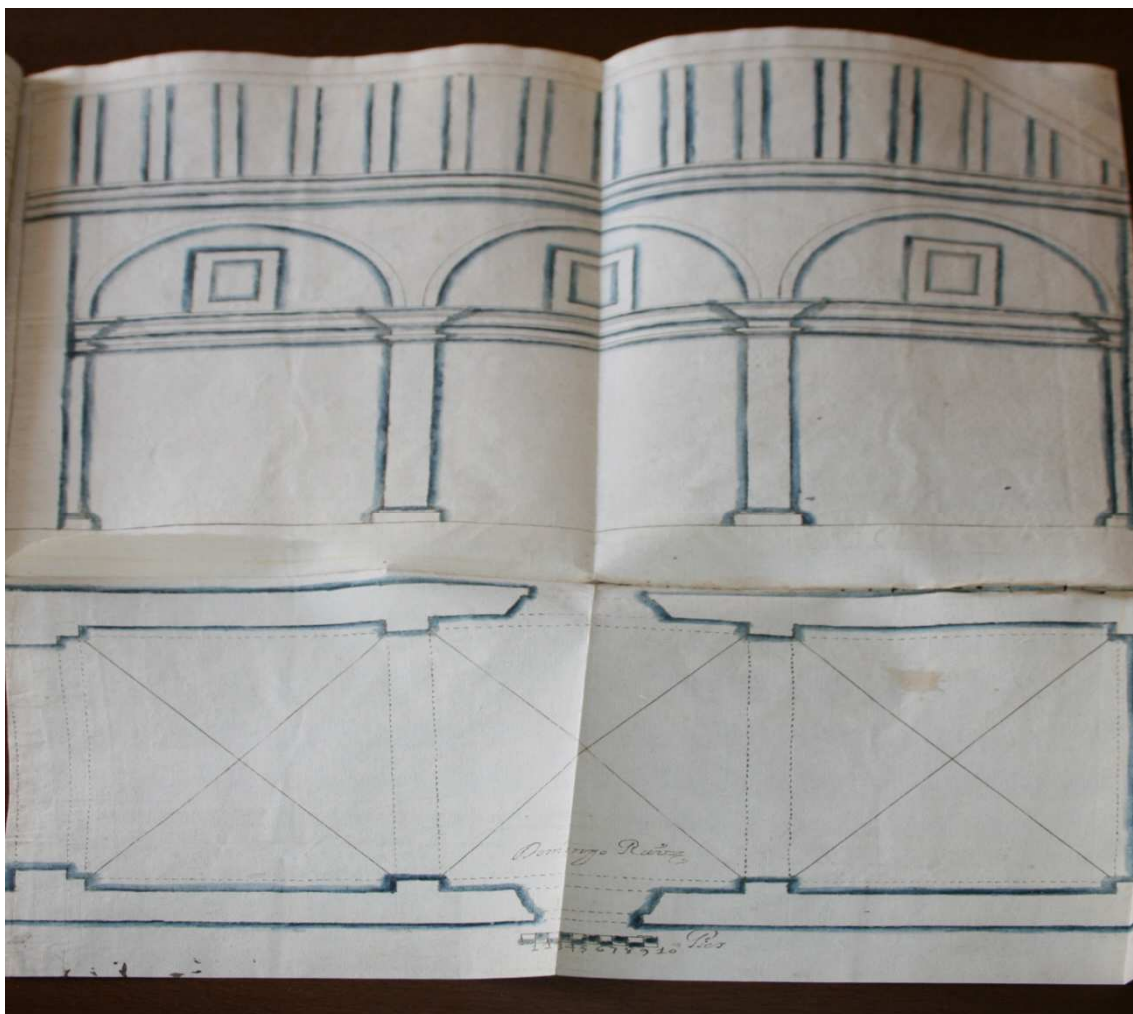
Alzado y planta para la parroquia de Tribaldos. 1710. Domingo Ruiz. A. D. C.
